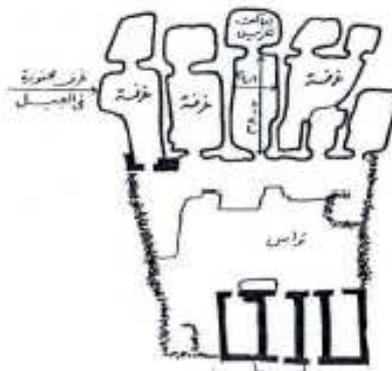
مسقط أفقي للطابق العلوي بدار ببلدة سالي
